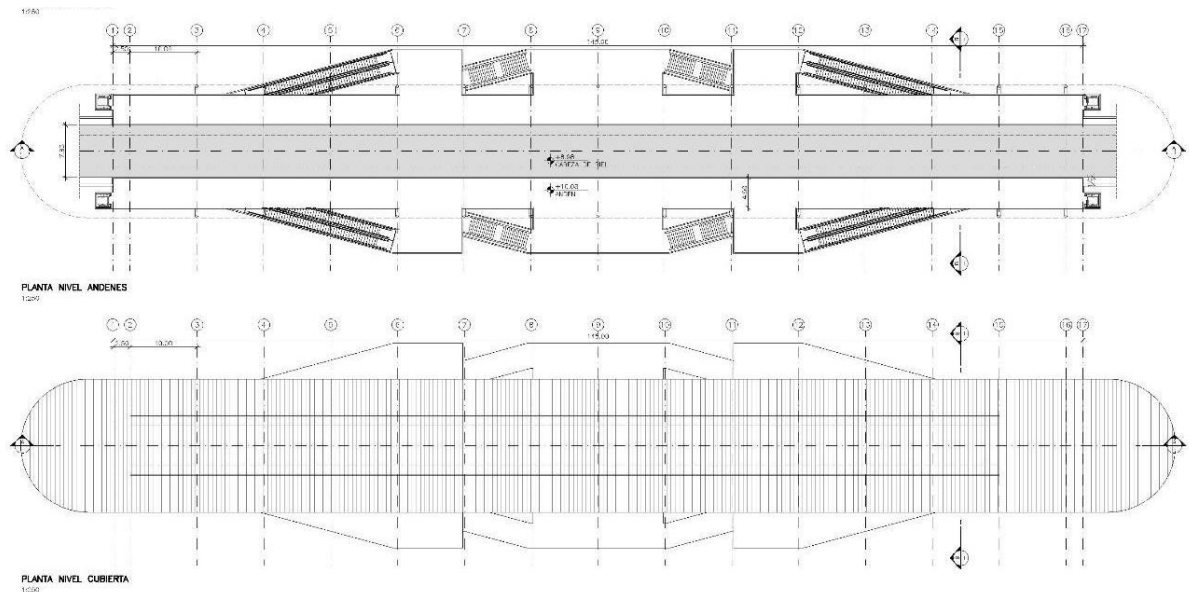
Planta Nivel Plataformas (-10,05)
